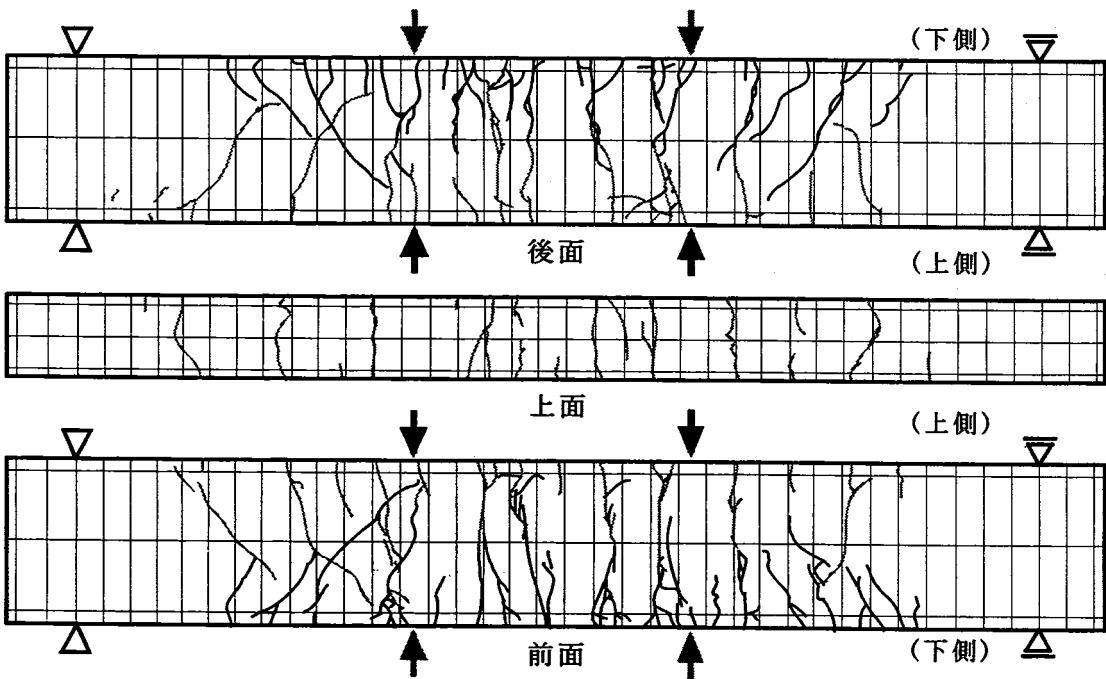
f) ひび割れ性状 [BS-3 ; R = 1/50rad.]
